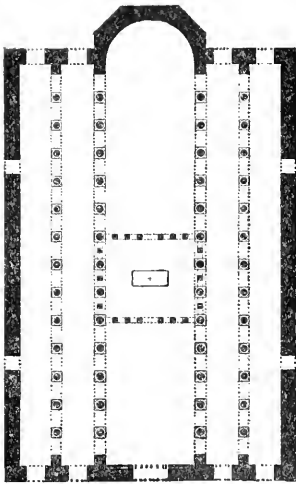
Grundriss der Basilica Ursiana zu Ravenna.
